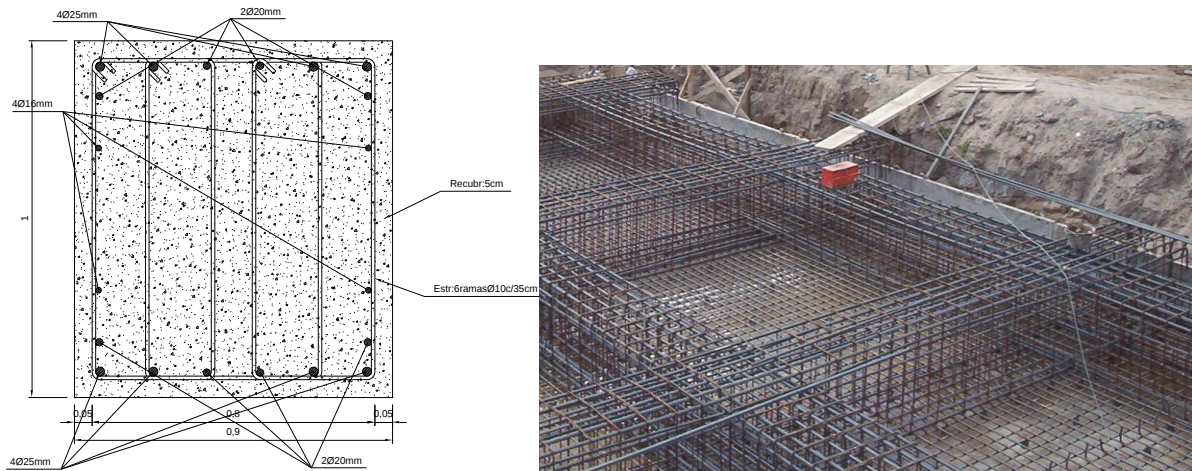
Corte y armado de vigas de alma ancha en una platea de fundación
